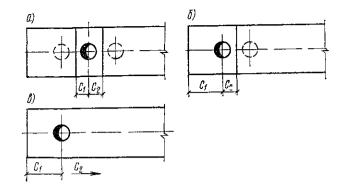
25 Расчетные схемы нагревательного элемента в перекрытии для определения границ поверхности геплоотдачи
